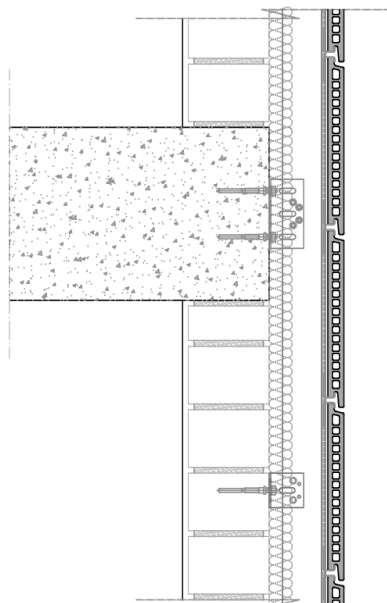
Sección vertical. Faveton® SAH Ceram 28.
